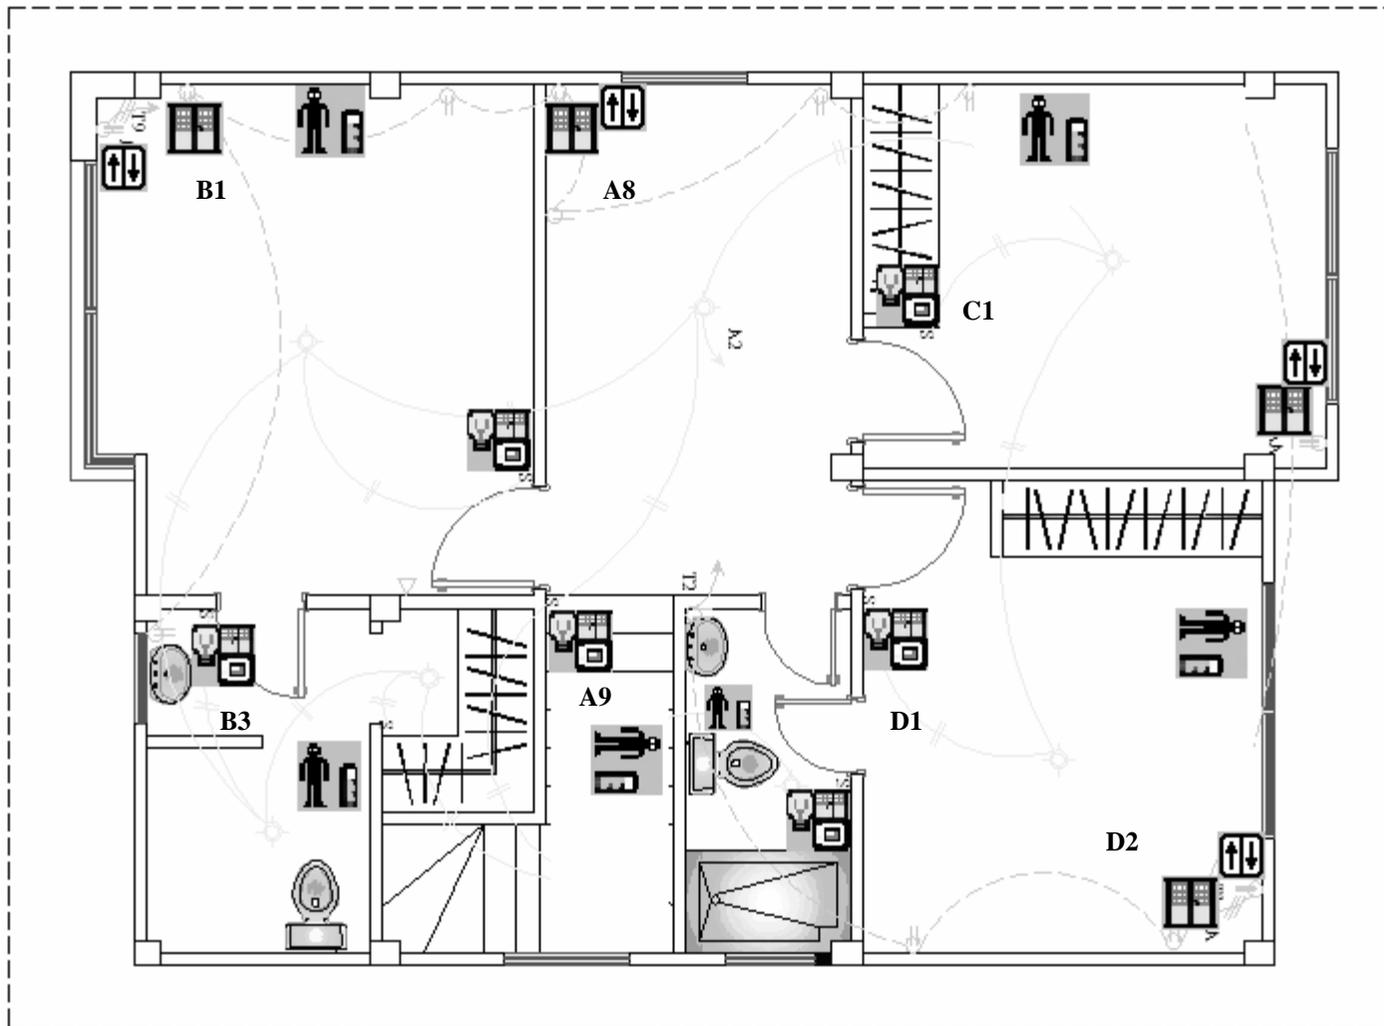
Sistema de Iluminación, Planta Alta, Plano Eléctrico.
